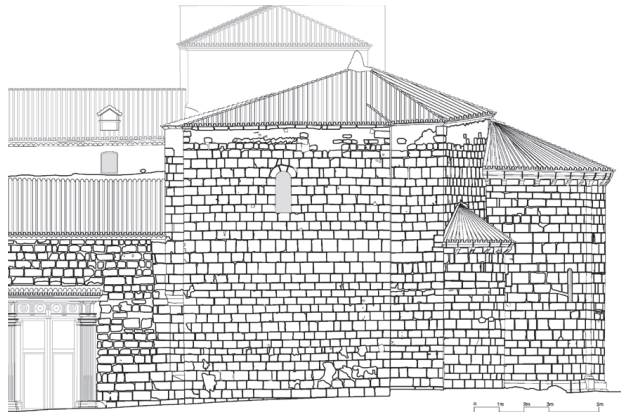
Representación gráfica de una planimetría crítica en un alzado.
